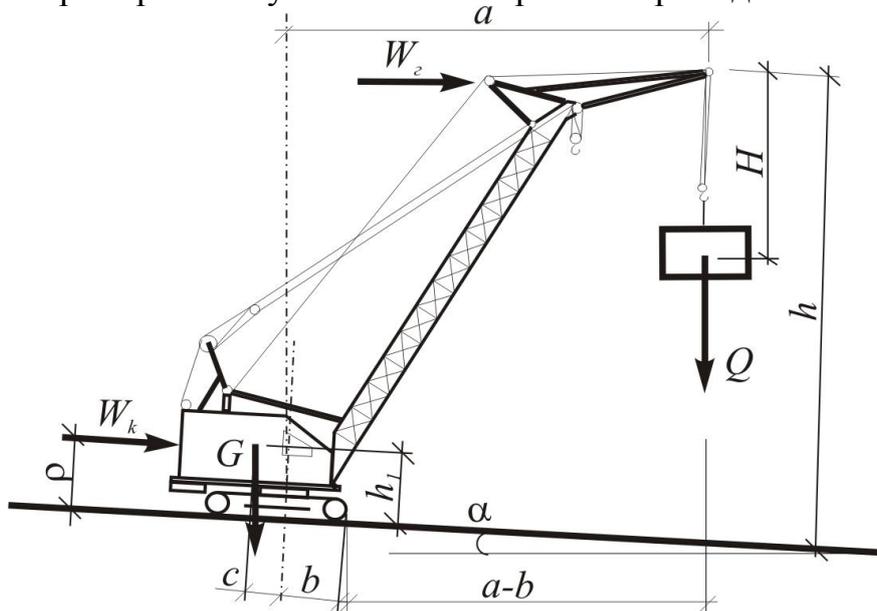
Розрахункова схема стійкості самохідного крана з вантажем
